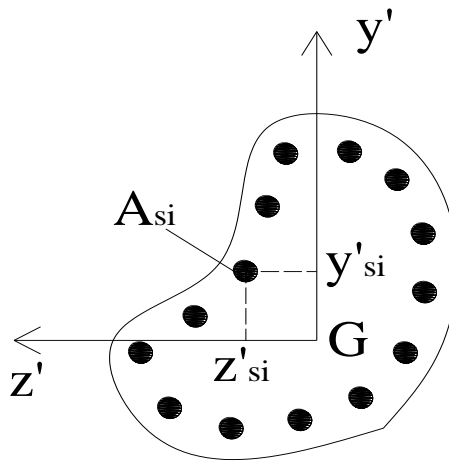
Sezione della trave in c.a.: area e posizione delle armature
